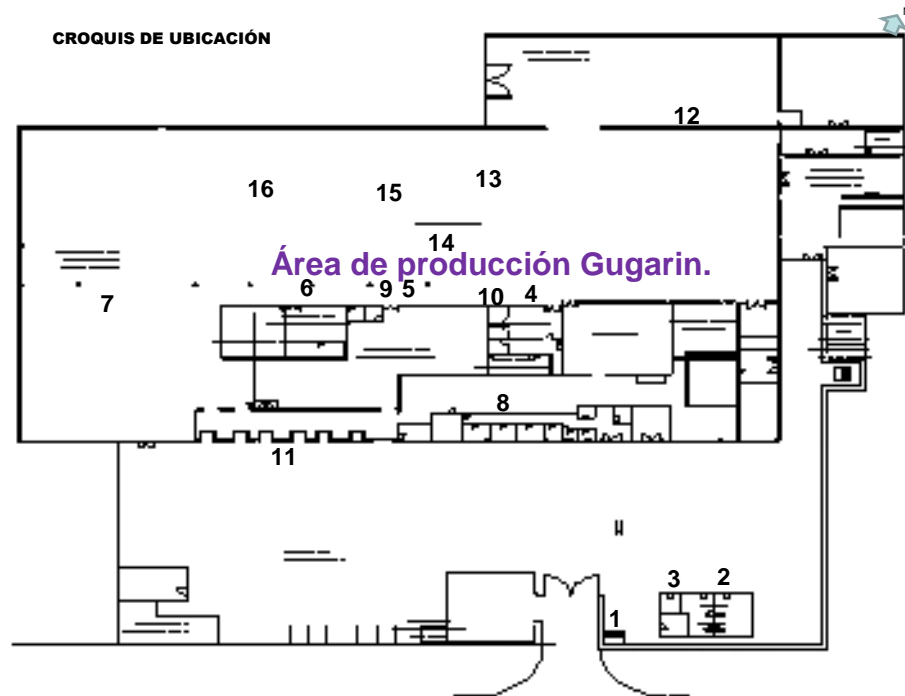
Distribución de la planta (Distribuidora Gugar S. A de C.V.)
